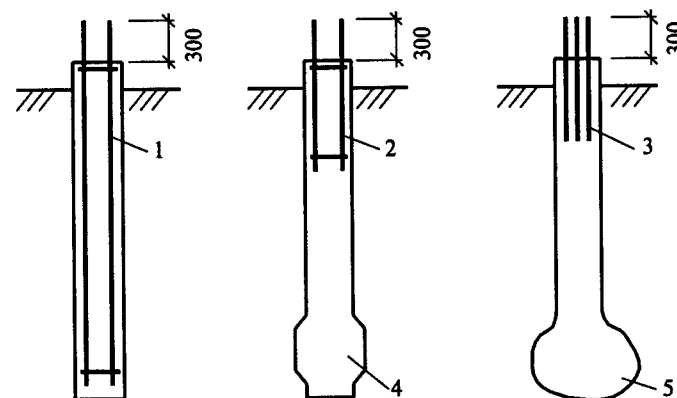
Буронабивные сваи: 1 — арматурный каркас на всю длину свай; 2 — арматурный каркас в верхней части свай; 3 — арматурные стержни; 4 — уширенная пята свай, выполненная механическим способом; 5 — уширенная пята свай, выполненная камуфлетным взрывом
